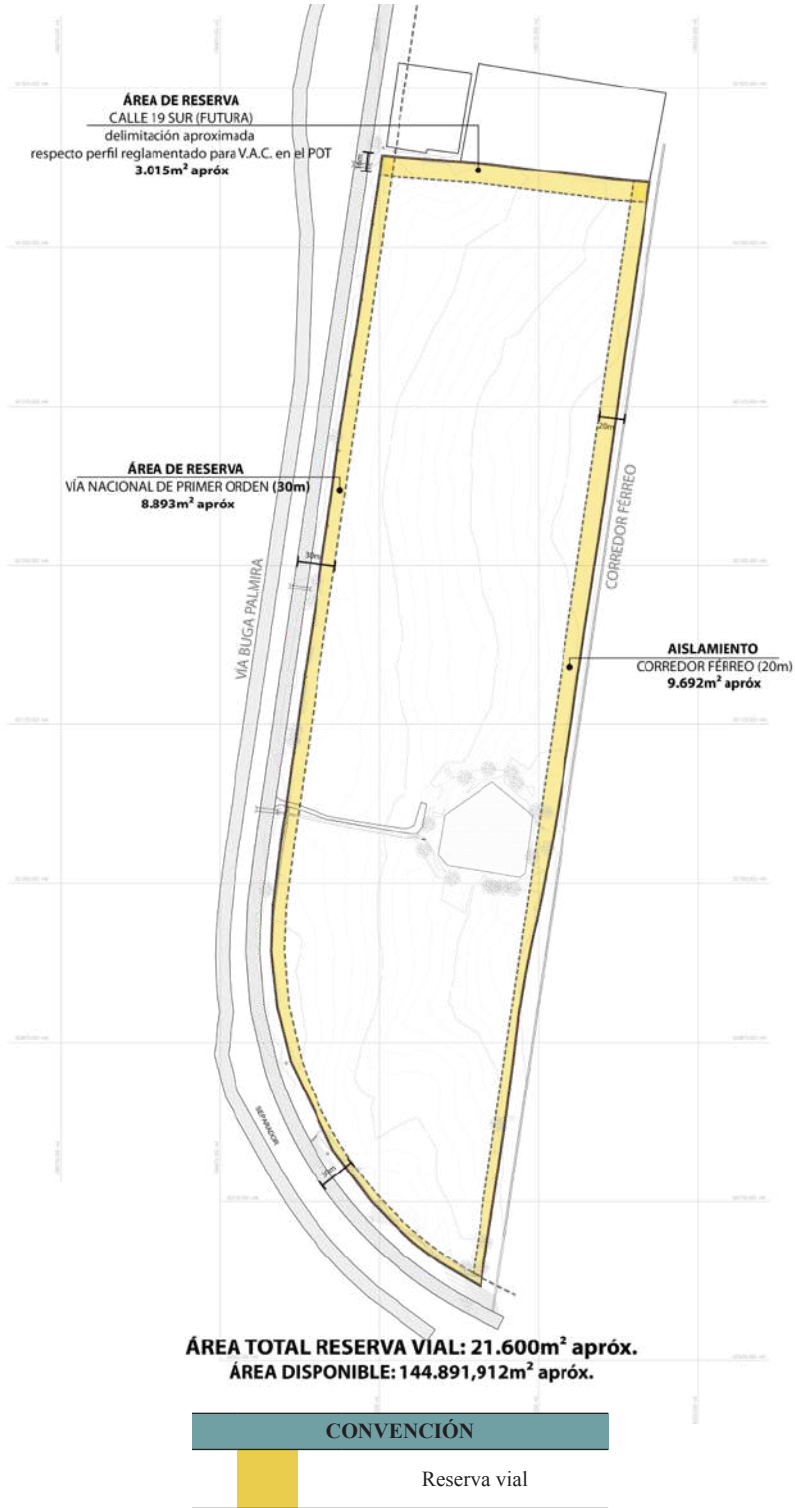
Fajas de protección vial. Elaboración área normativa UD. Fecha elaboración: 04/11/2016
